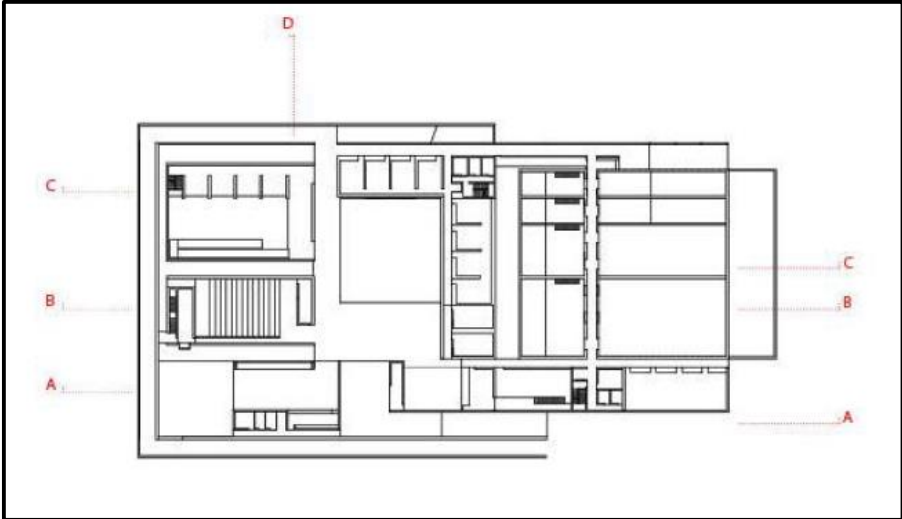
Plan niveau 0 du musée Madinat Al-Zahra
